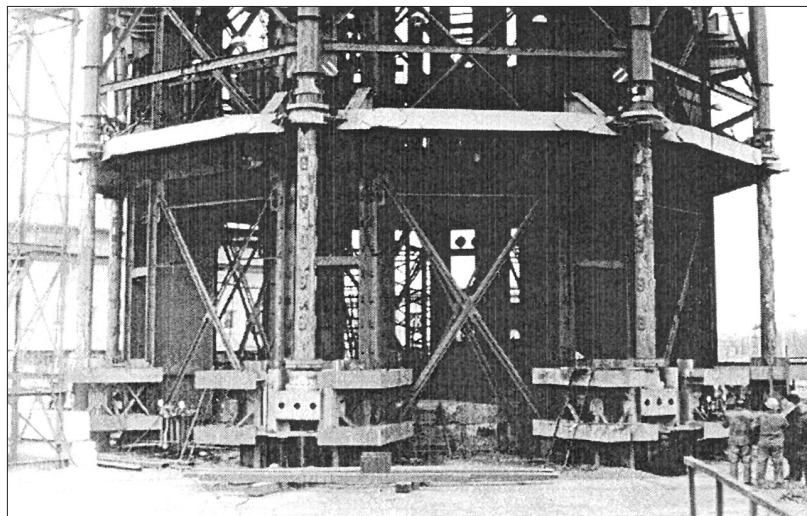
Общий вид подъемно-сборочного агрегата ДПС-8
